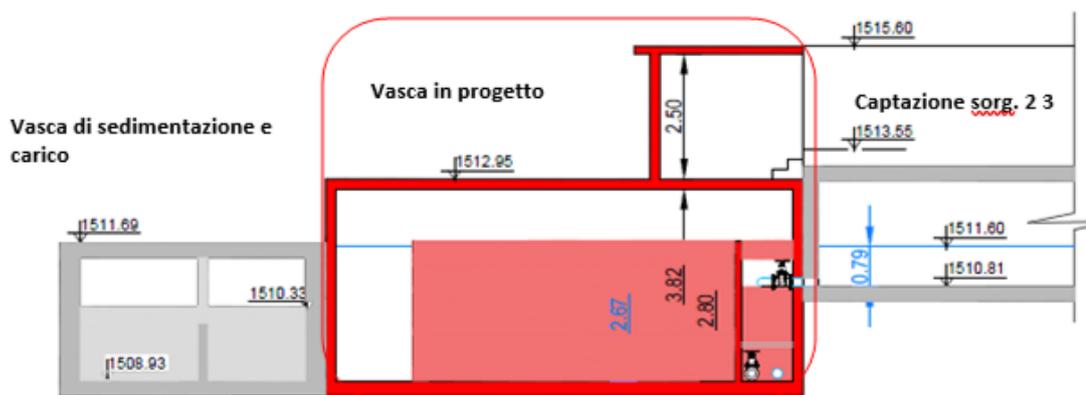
Sezione serbatoio in progetto. (Allegato 2)
